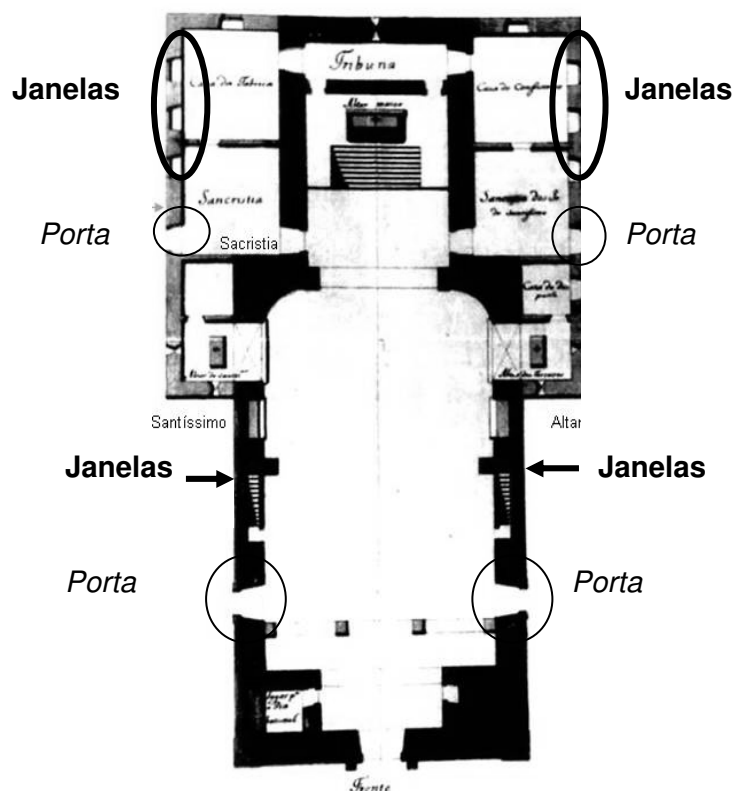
Localização em planta das aberturas laterais executadas em 1773
